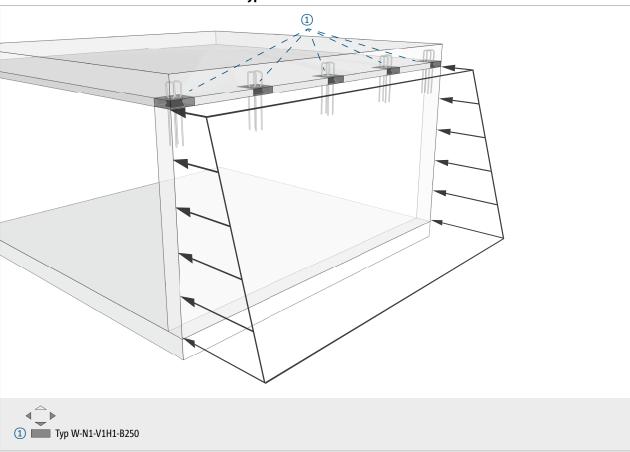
Erddruckbelastete Wand unter Decke getrennt
